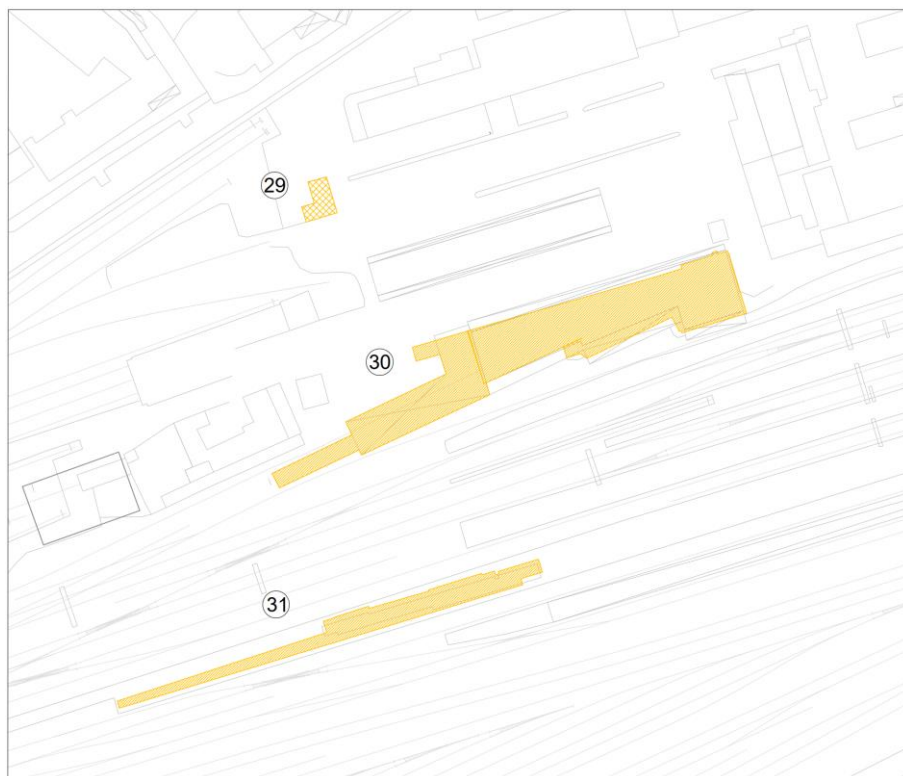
Stralcio planimetrico zona Stazione Verona Porta Nuova
